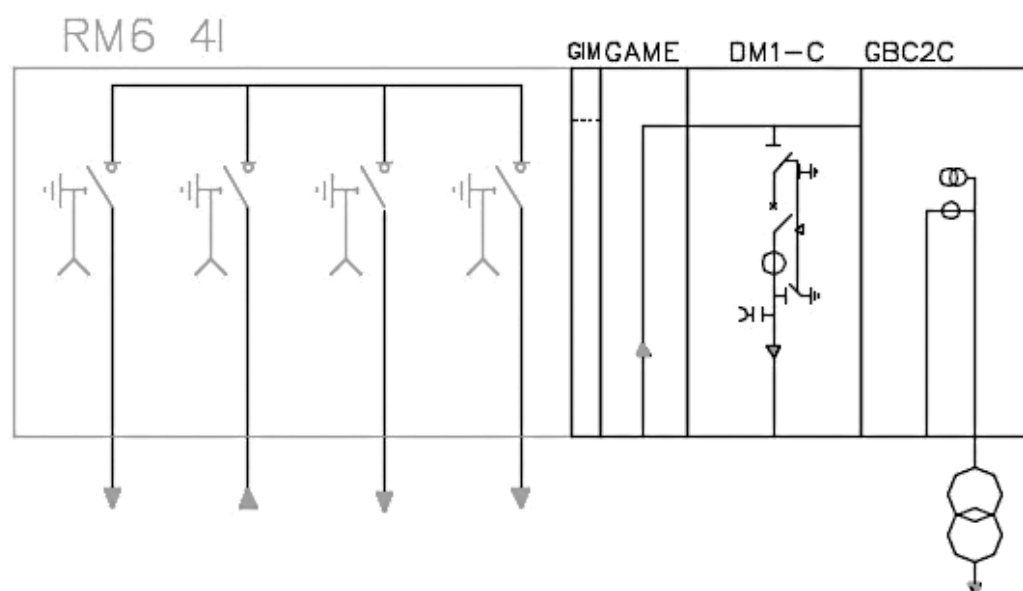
Esquema eléctrico aparamenta alta tensión Fuente [\[9\]](#)
